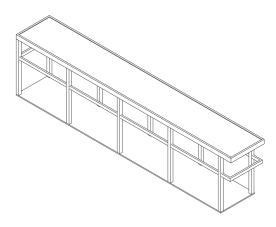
Axonometría estructural tipo 2_8 Fuente: Autores, 2024
